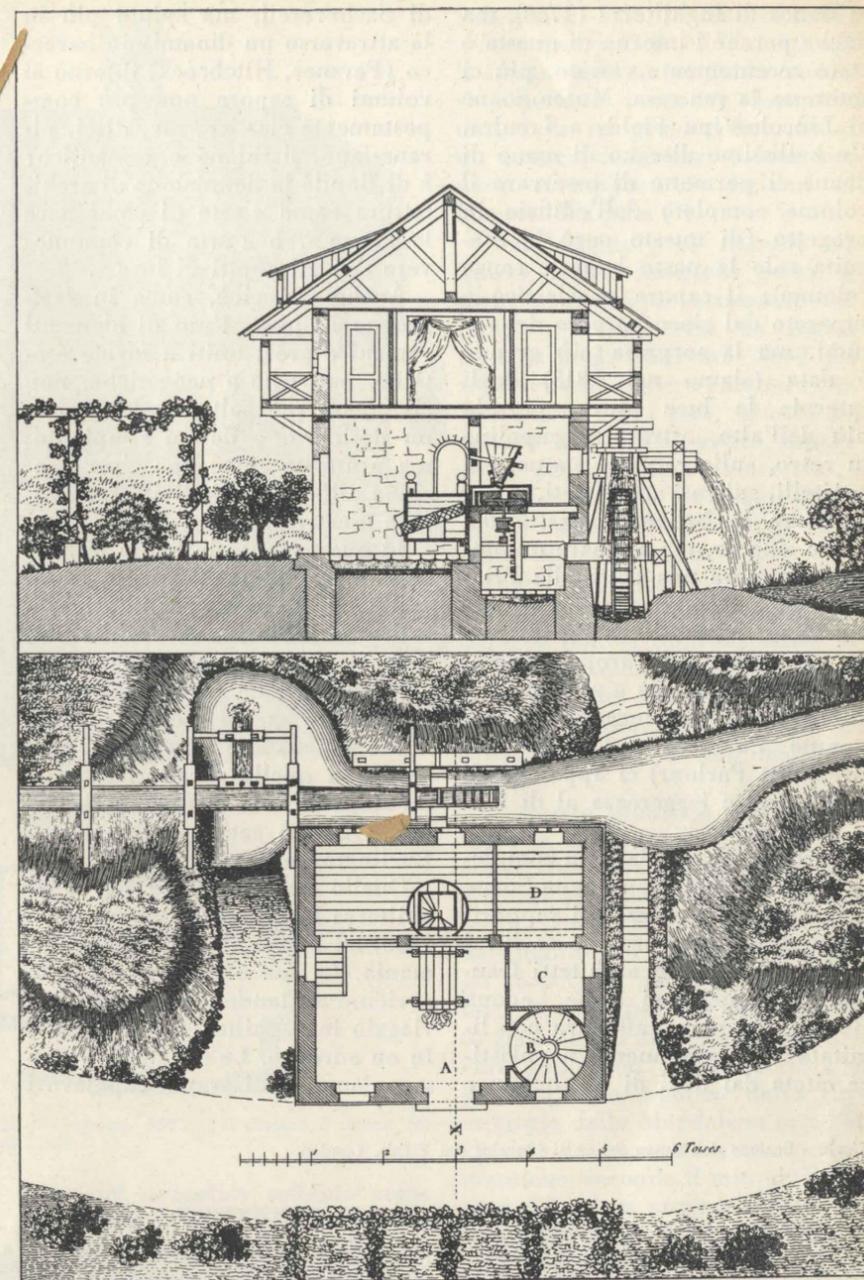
Pianta e sezione del mulino. (da J. Ch. Krafft, Paris 1809)
